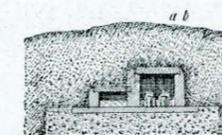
Sezione trasversale d'un pozzetto e della galleria secondaria di allacciamento su *ab* della fig. 6.
